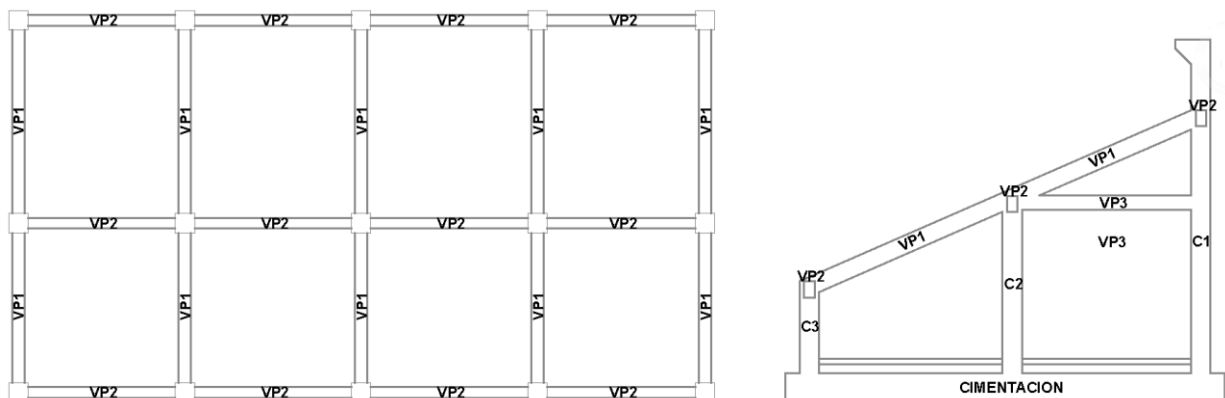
Vista en planta y elevación de los elementos principales del PERM.
